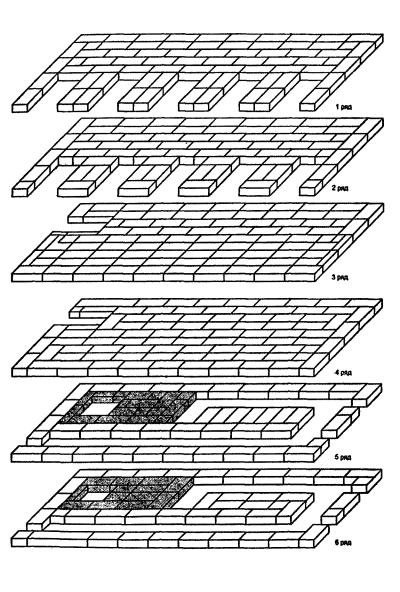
Кладка отопительной нечи № 4A с лежанкой
